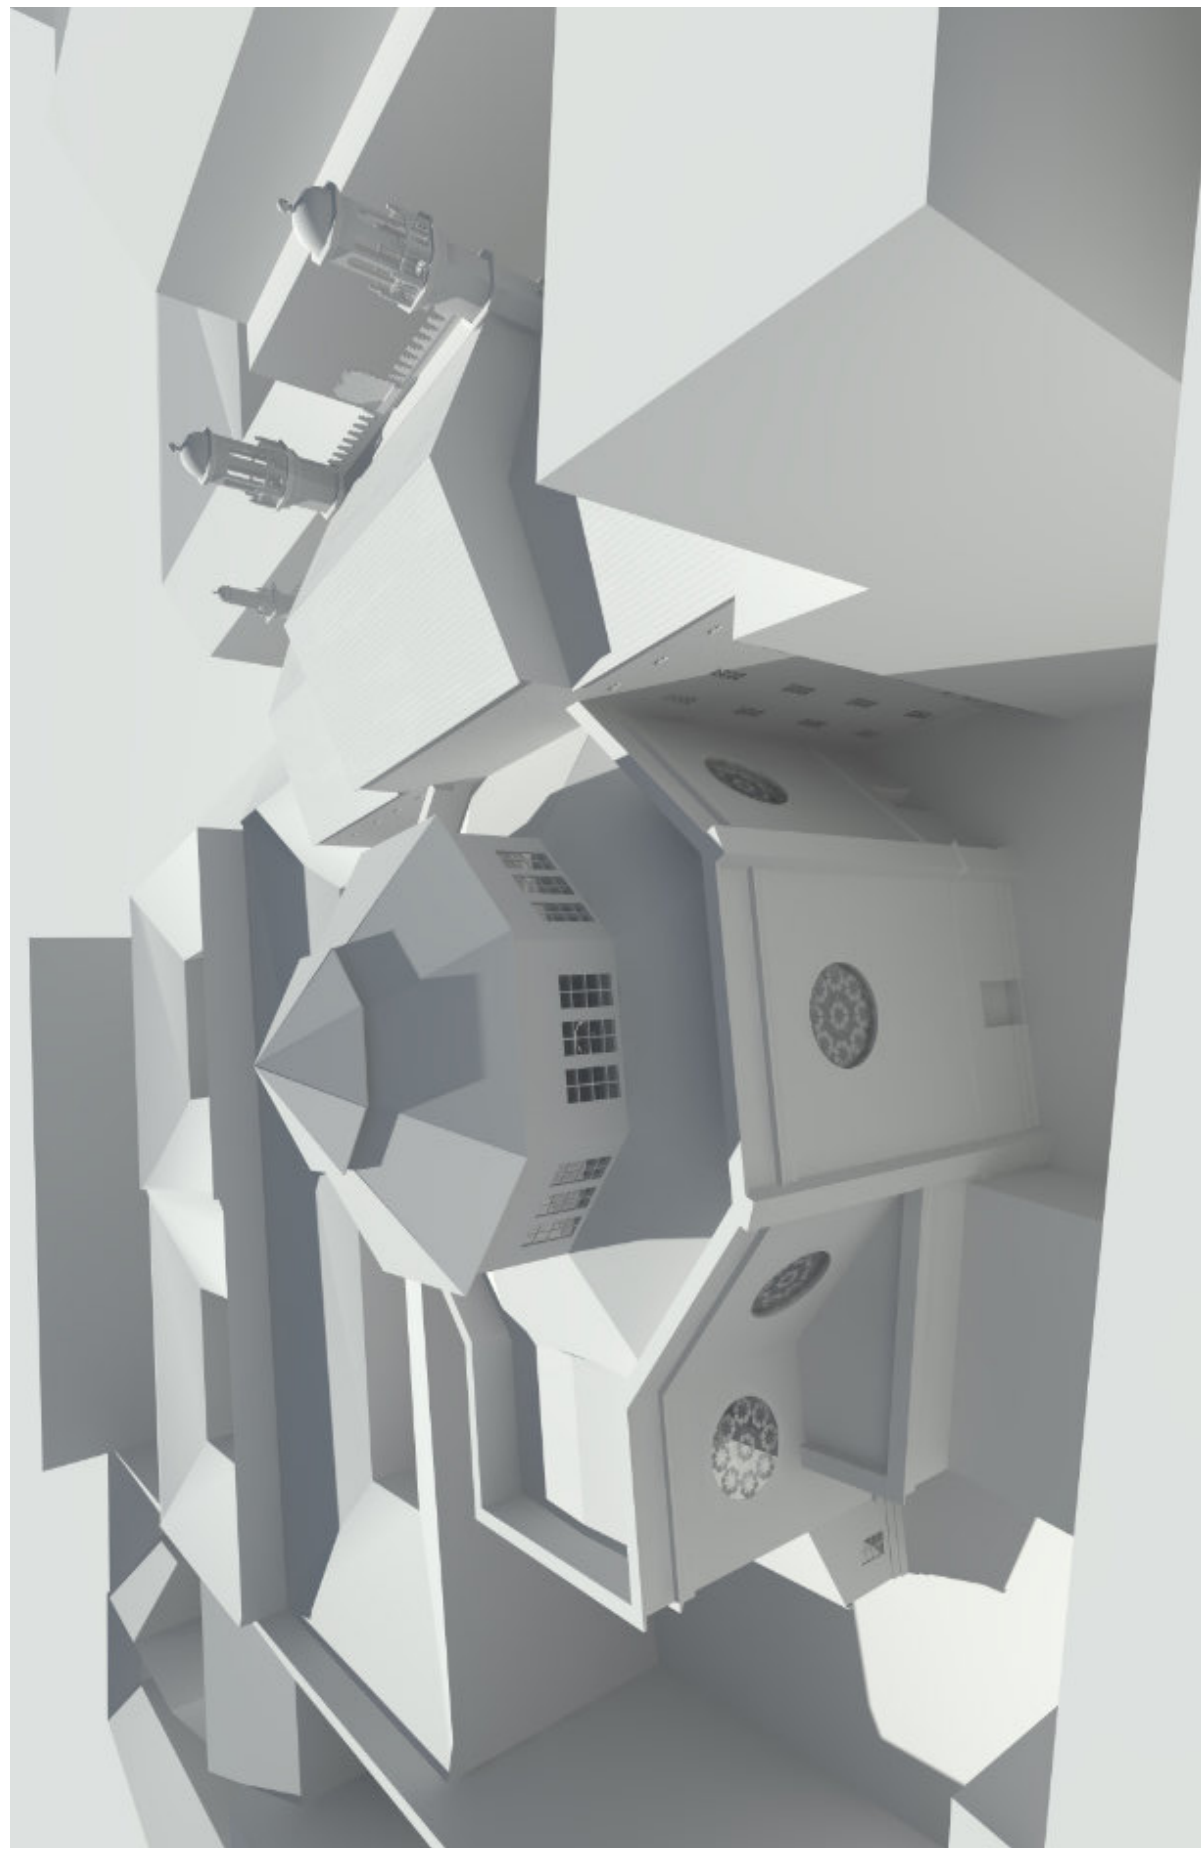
3b.: Außen 02 - Nordfassade, Städtebauliche Situation, Weißrendering.
